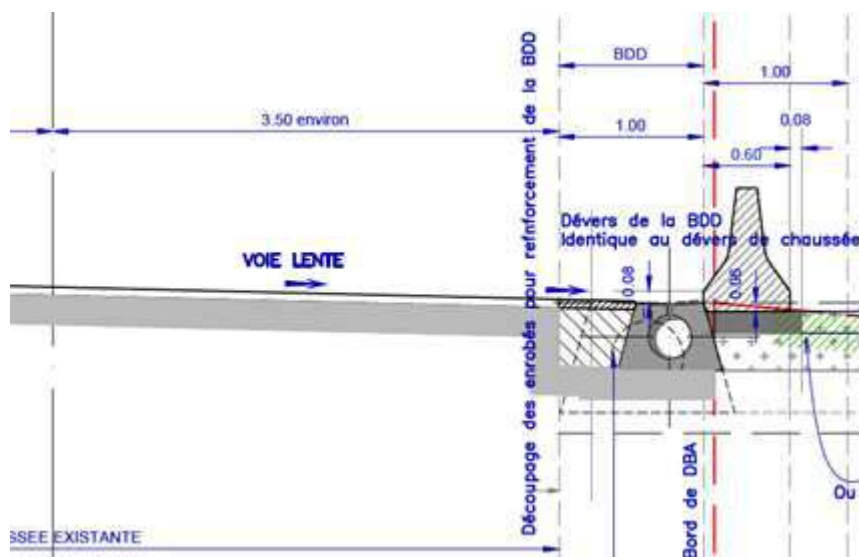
ASSAINISSEMENT LONGITUDINAL PAR CANIVEAU À FENTE
